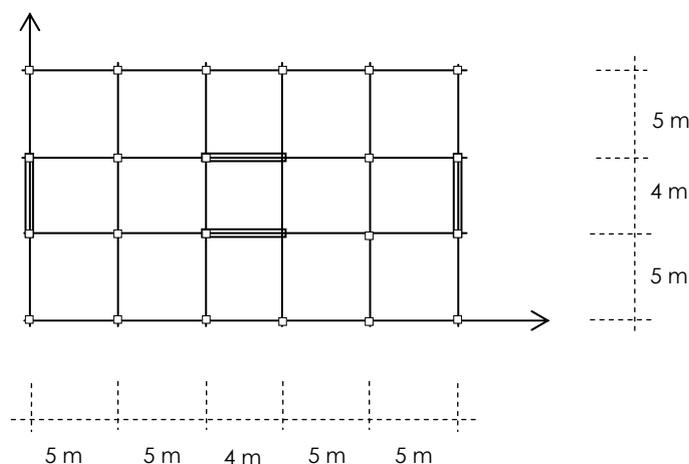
Esquema en planta de la estructura (autora: L. Basset)
